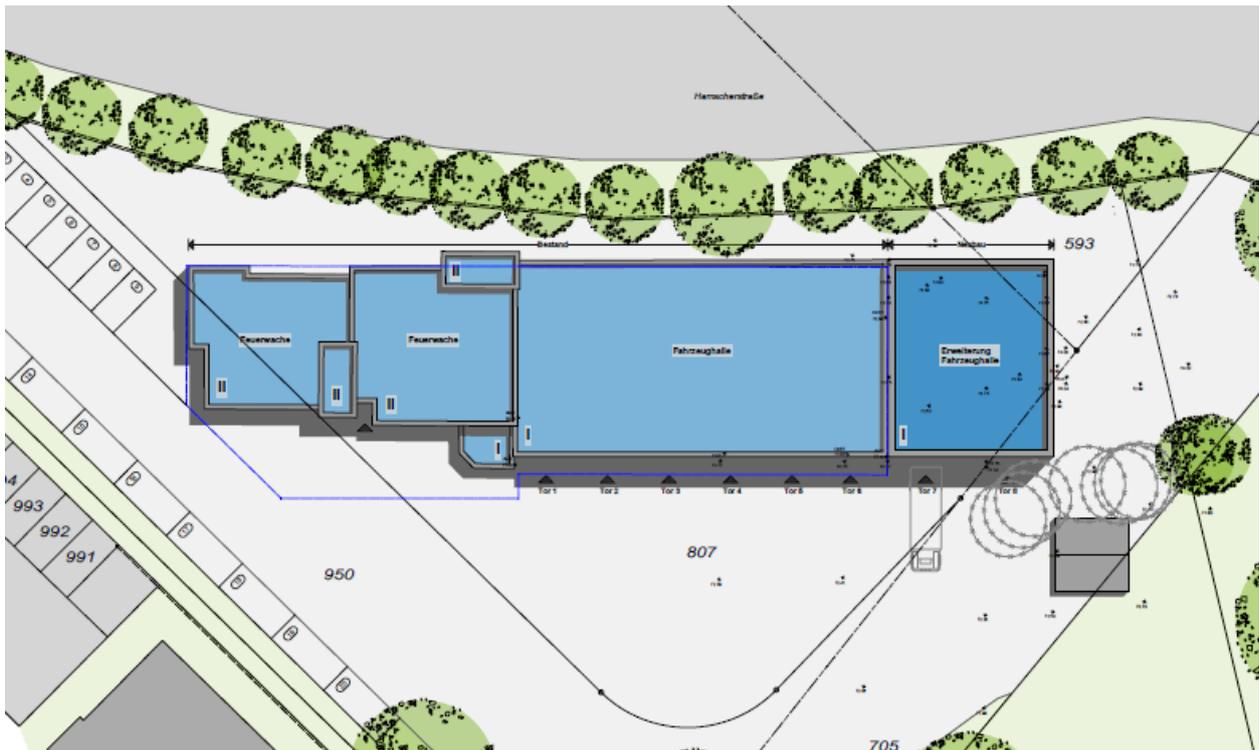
Bestandsgebäude und geplante Erweiterung
